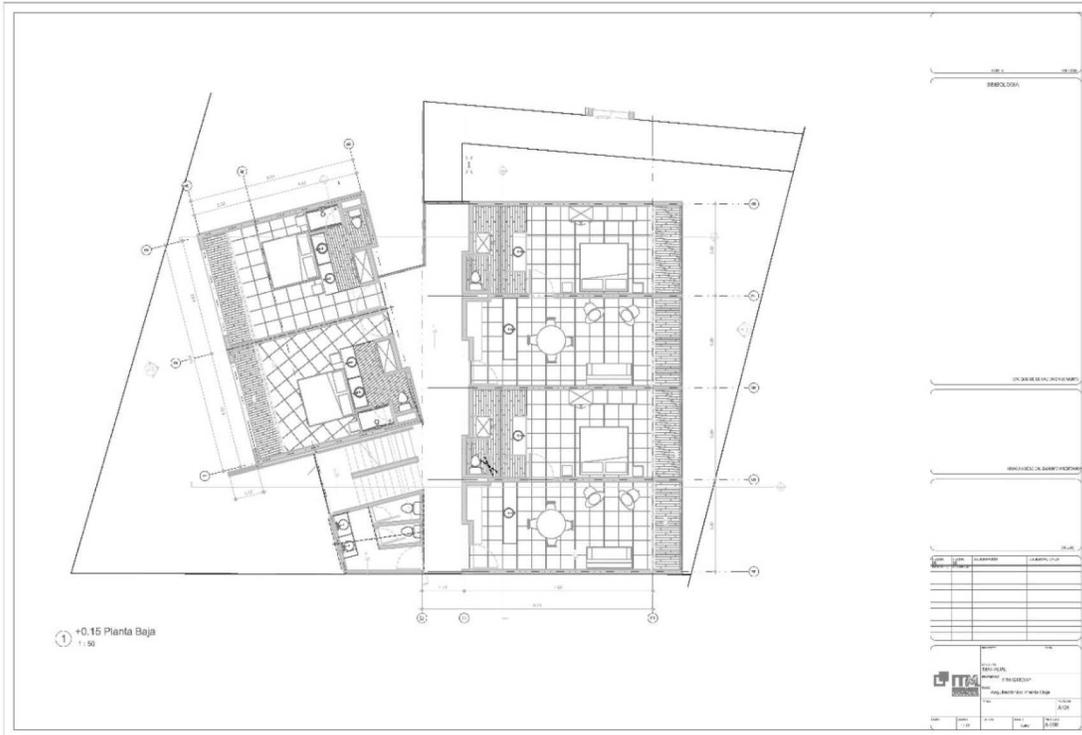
Plano arquitectónico del hotel 1er nivel.
